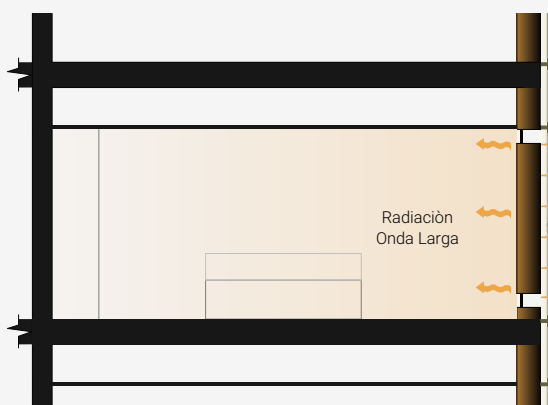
Muro acumulador térmico ventilado o Muro Trombe
